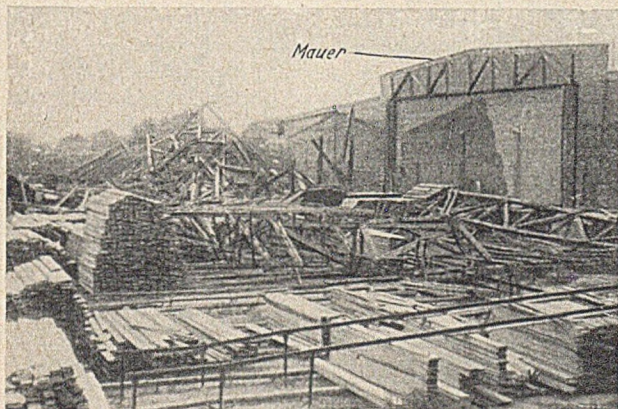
Die eingestürzte Holzhalle mit ihren Holzstapeln. Rechts die massive Hauswand mit dem Holzfachwerkbinder in der Mitte.
